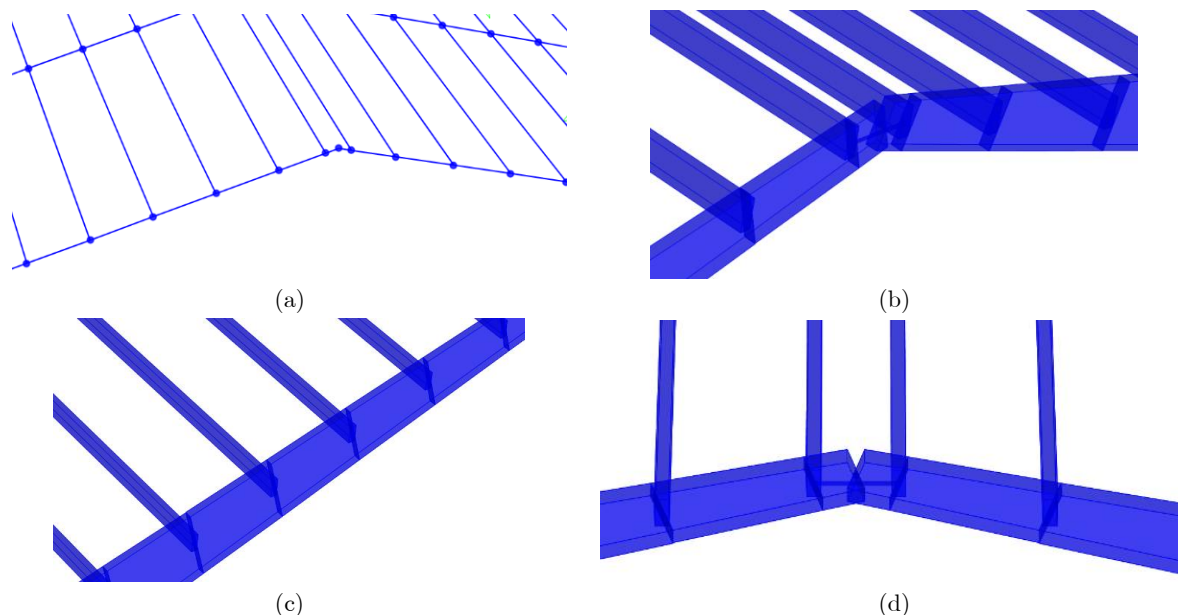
Pormenores de ligação entre as vigas e as longarinas: a) vista 3D das vigas e longarinas; b) representação da ligação viga com viga; c) divisão da viga em troços de acordo com as longarinas; d) representação da ligação viga com longarinas.
